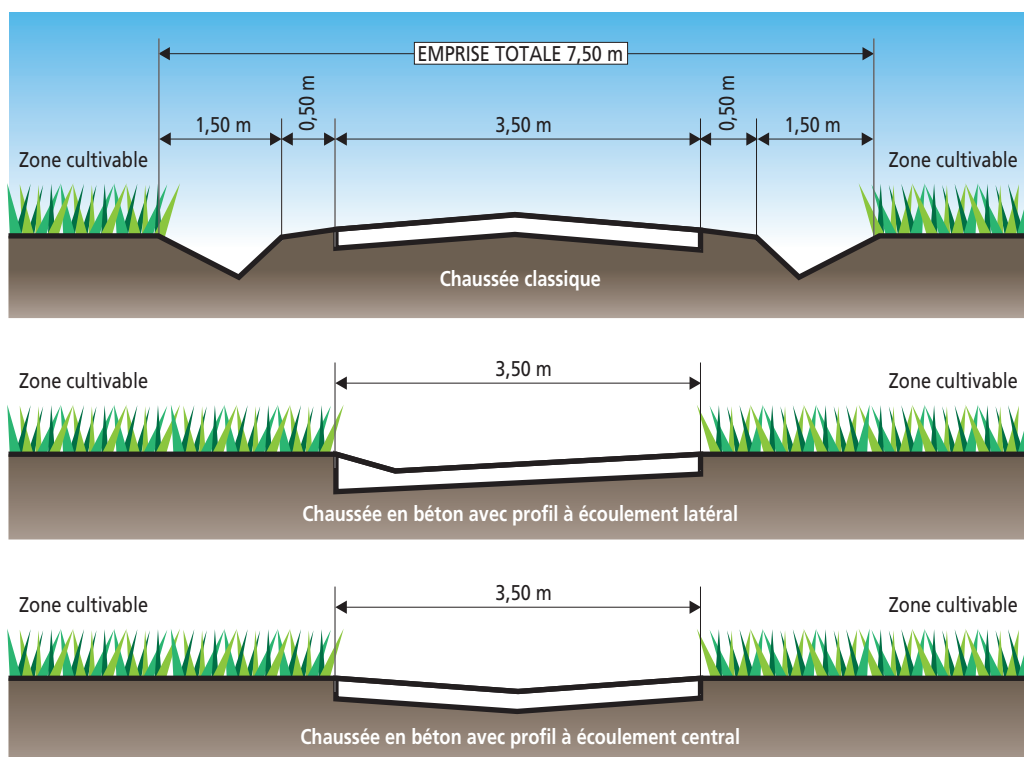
Profils en travers types d'une chaussée classique et d'une chaussée en béton
